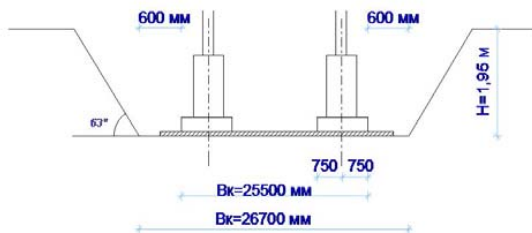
Разрез котлована со столбчатыми фундаментами
